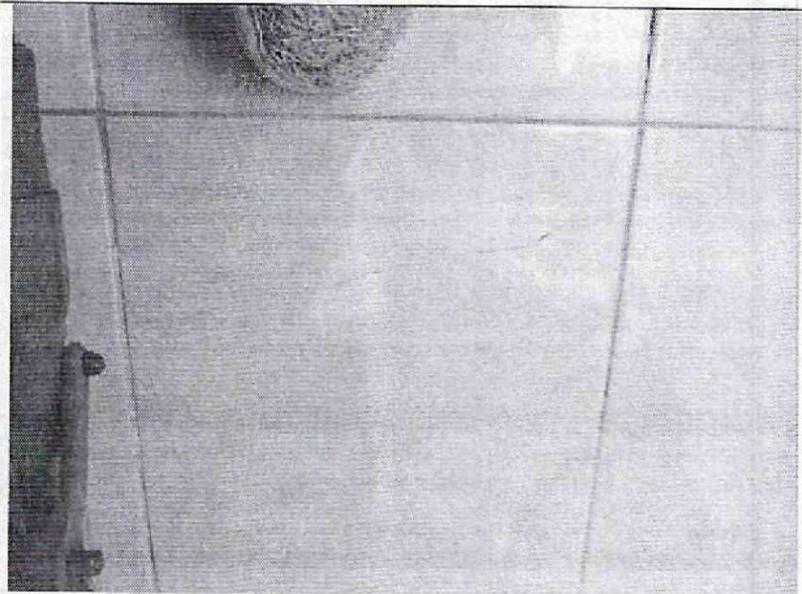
Fisuras en acabados de muro del tercer piso.
